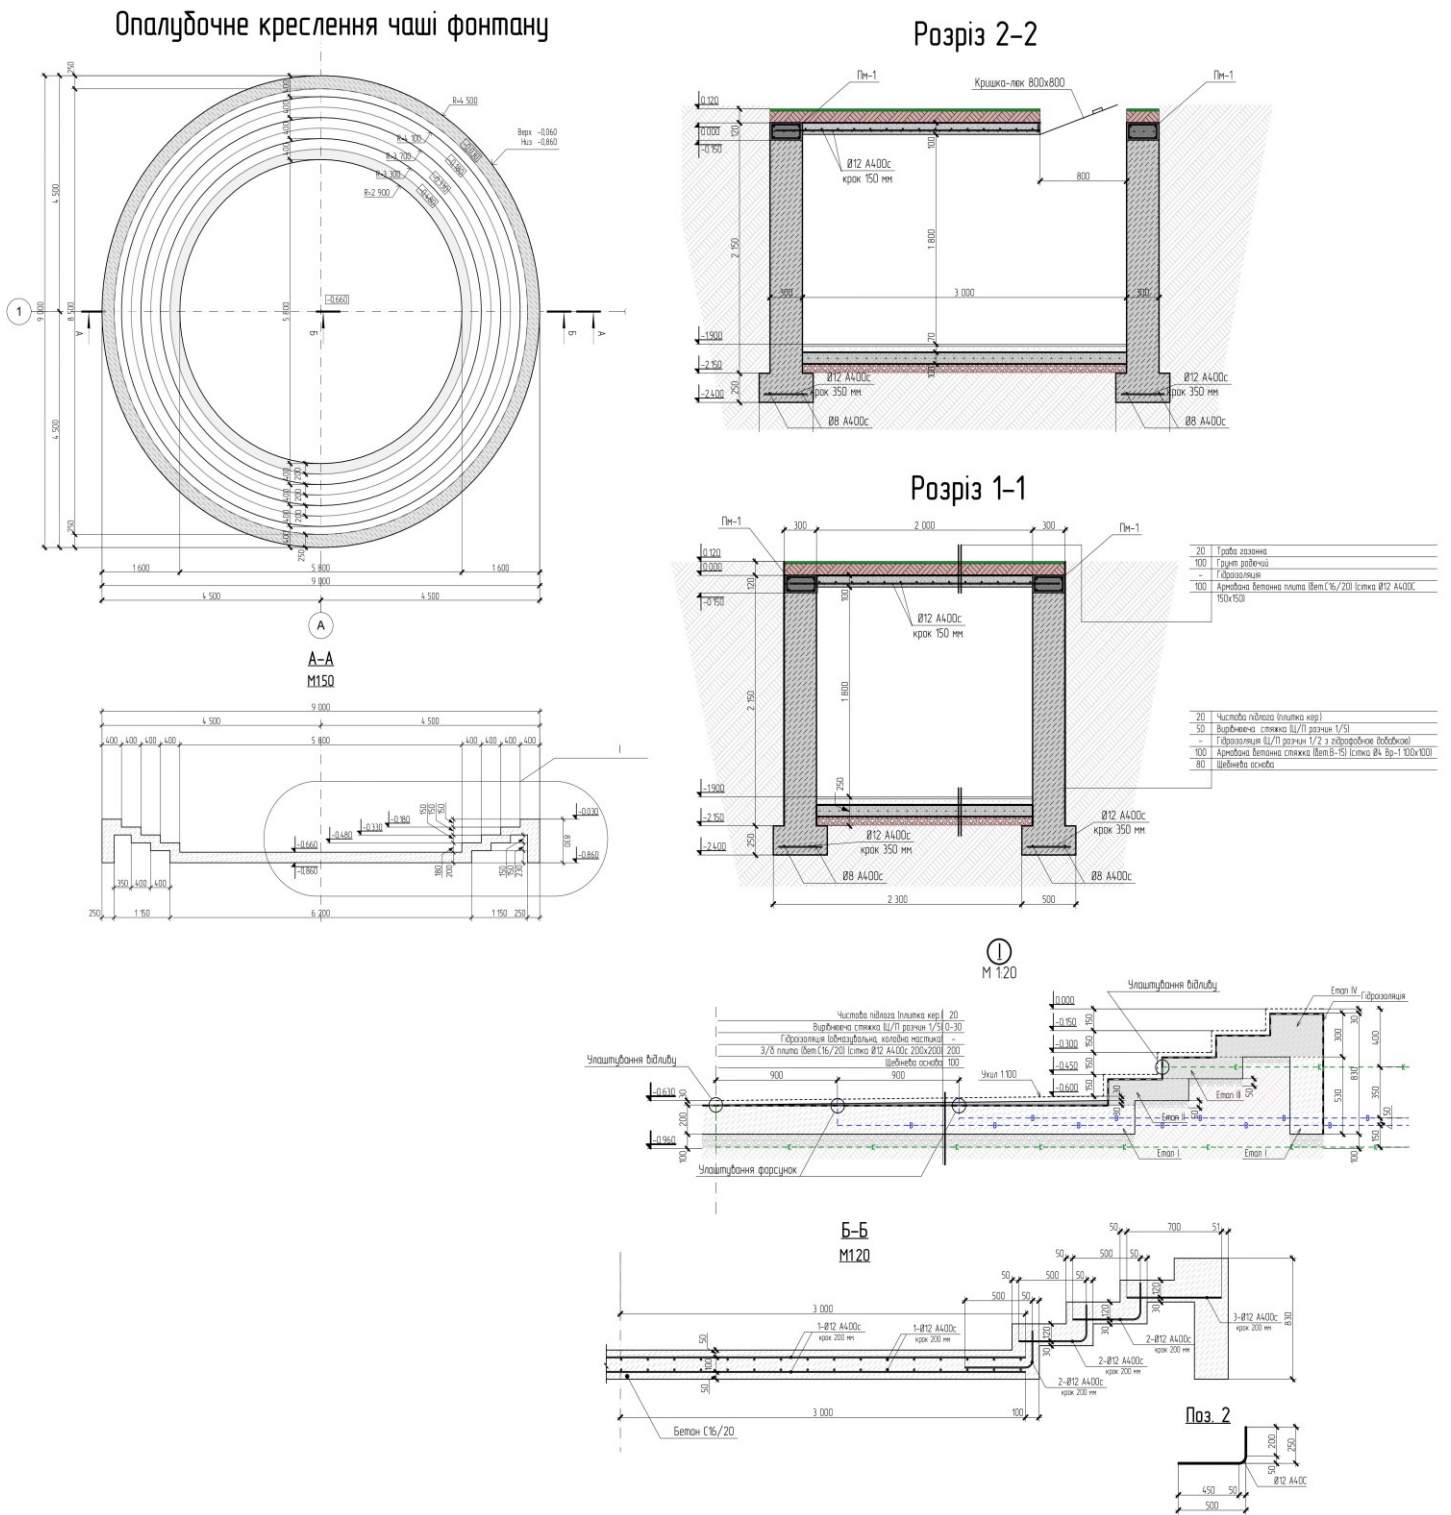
Вузли конструювання та армування фундаментів фонтану
